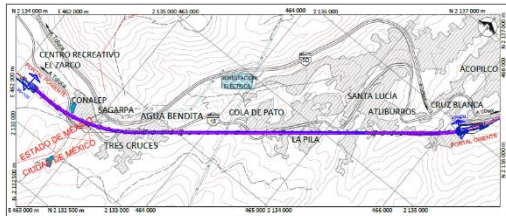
Planta de localización del bitúnel proyecto TIMT.
